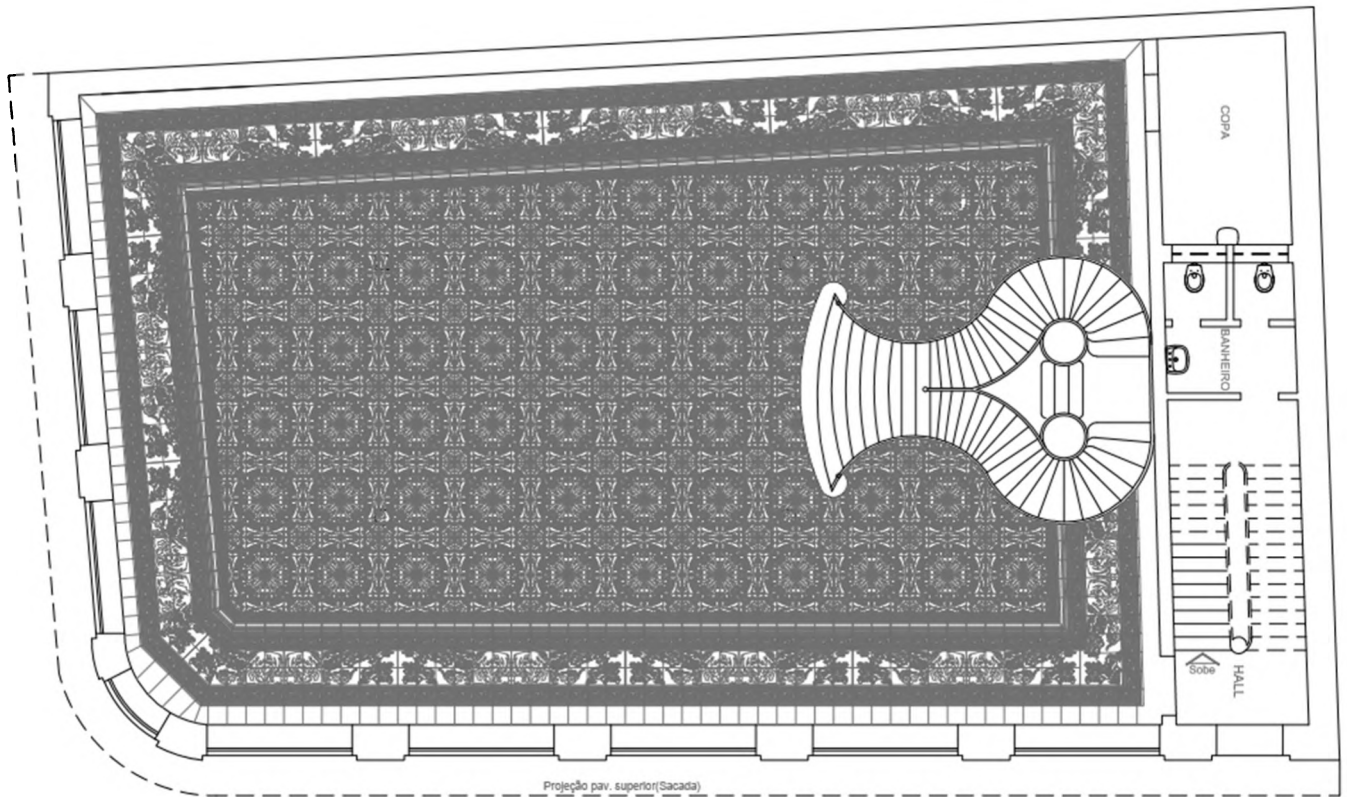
Planta do piso do pavimento térreo e ladrilho hidráulico. Detalhe do tapete interior.
